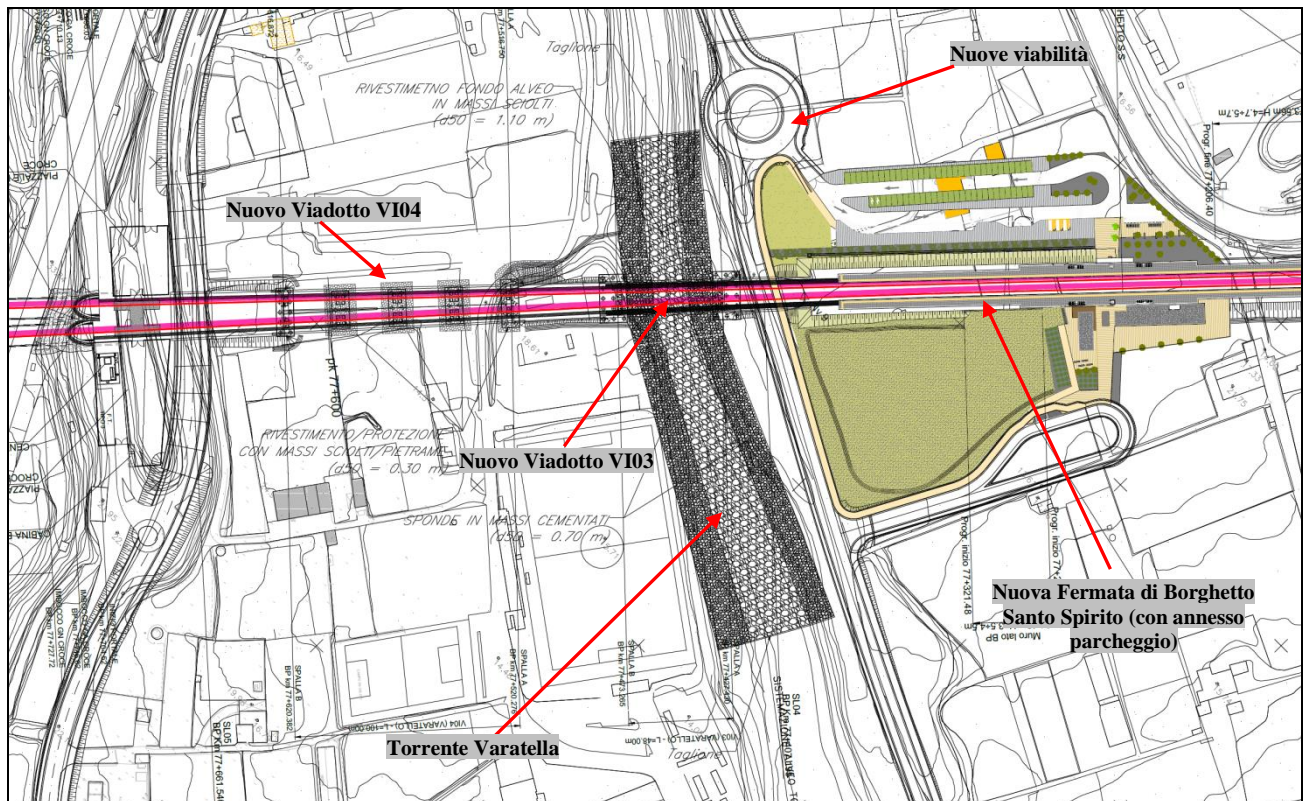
Stralcio della planimetria di progetto in quel di Pietra Ligure
